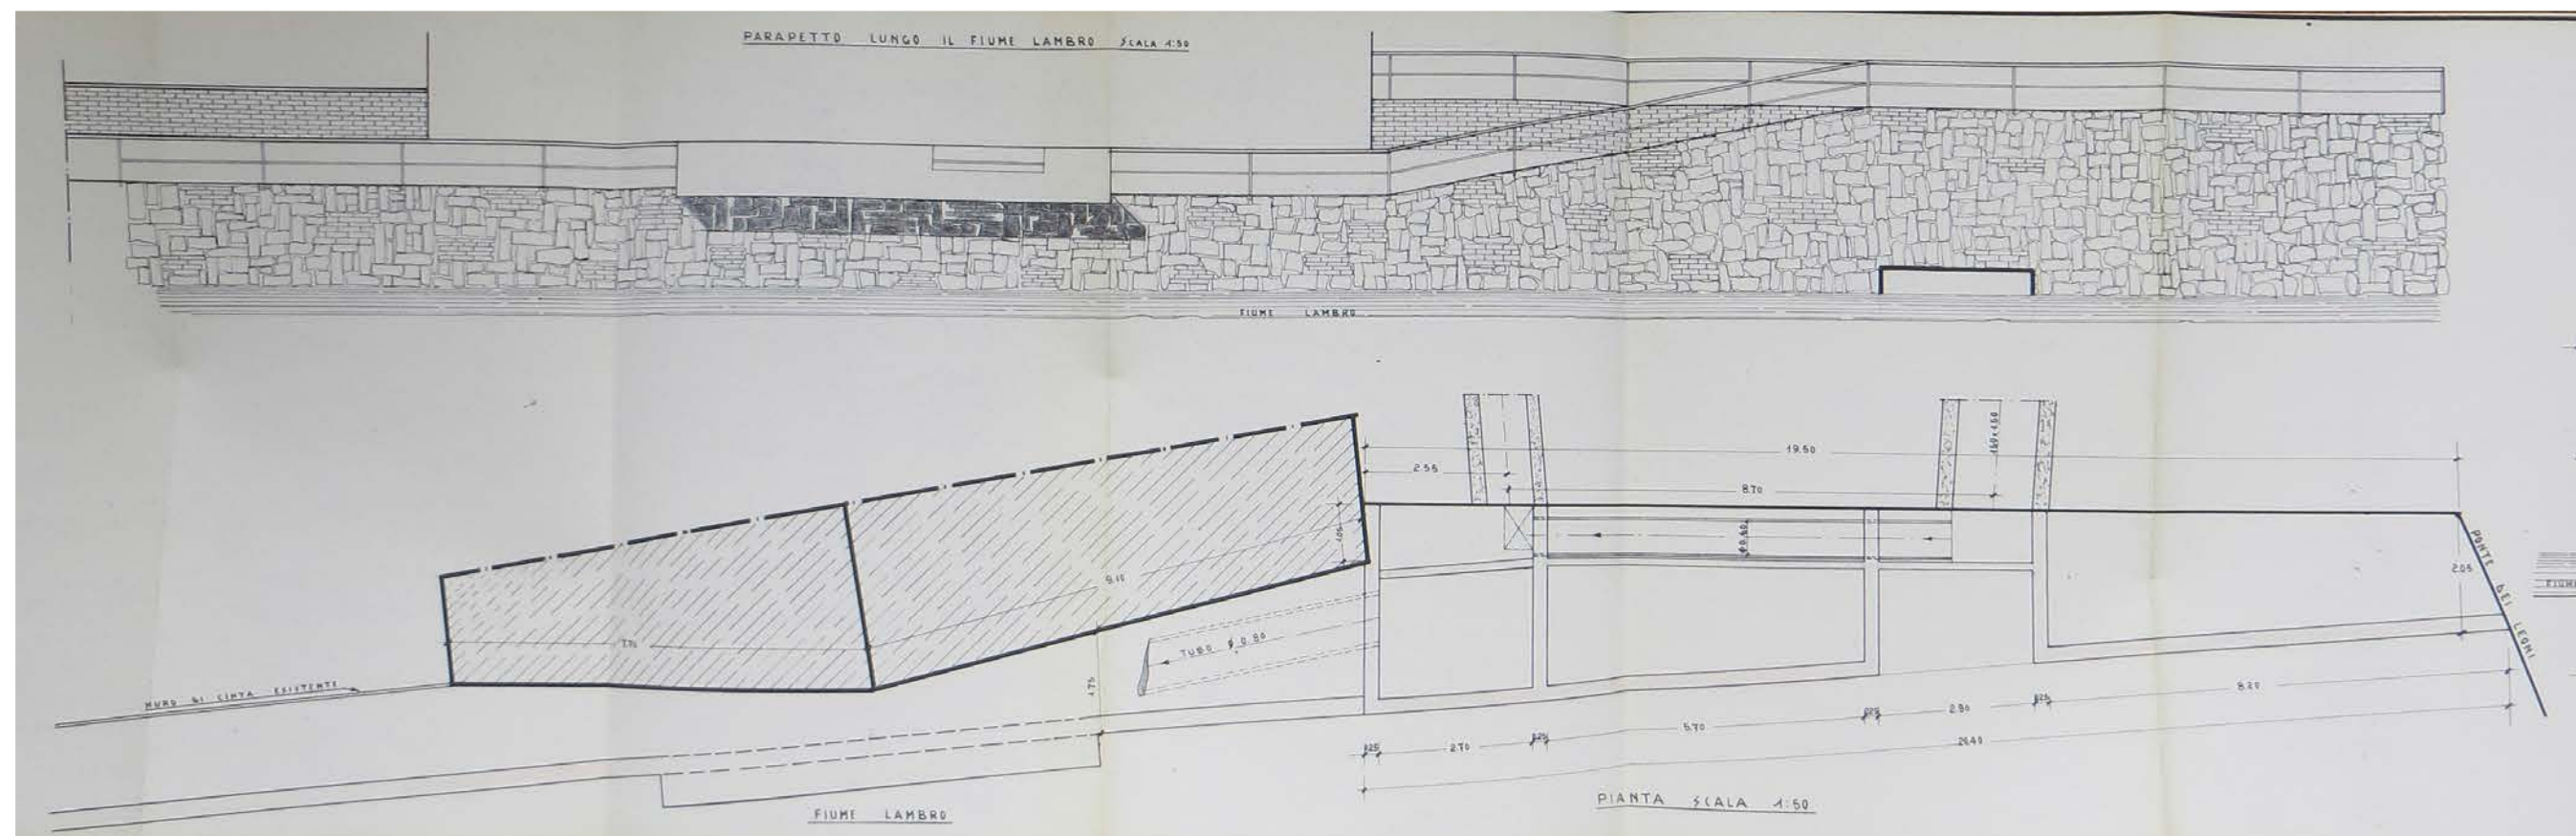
Parapetto lungo il fiume Lambro e pianta
